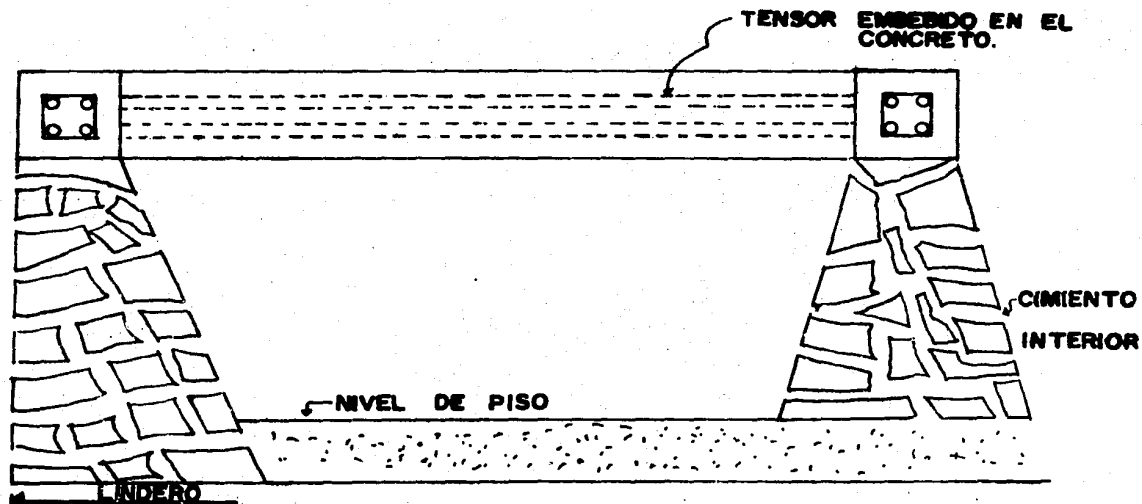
DIFERENCIA DE NIVELES ENTRE UN CIMENTO COLINDANTE Y UN INTERIOR (14)
